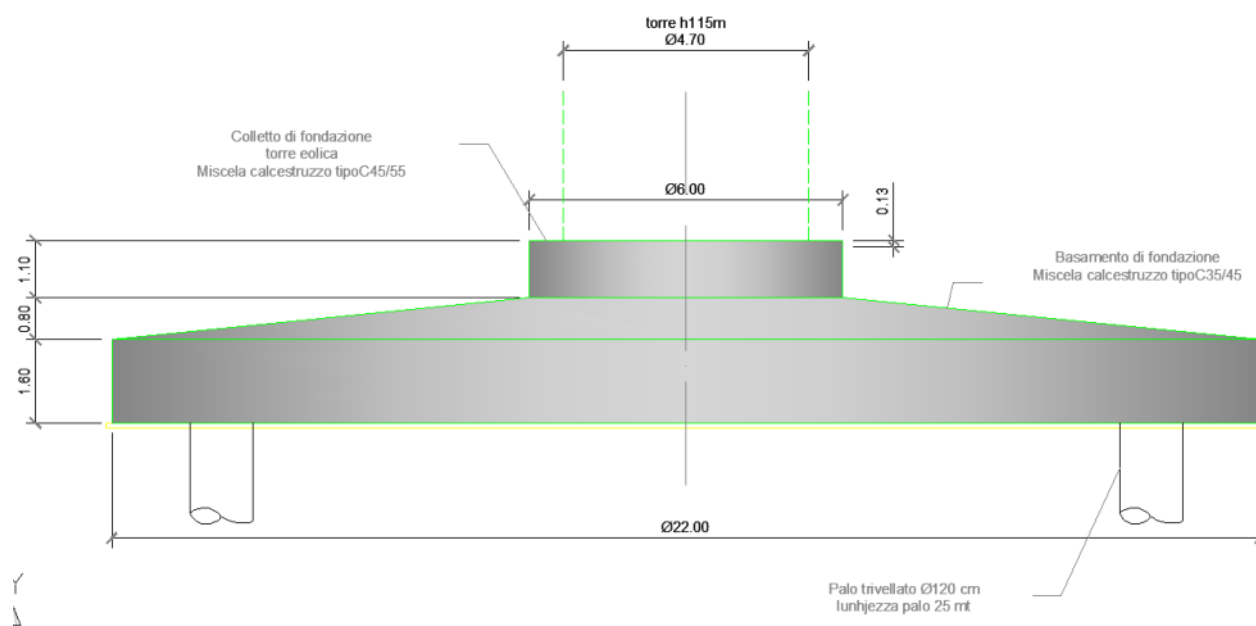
Dettaglio sezione basamento di fondazione in progetto
